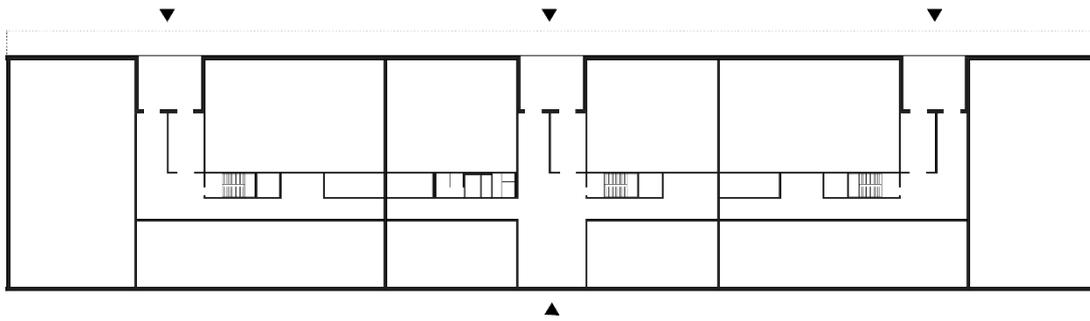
Vorentwurf Grundriss Erdgeschoss Kleingewerbe
